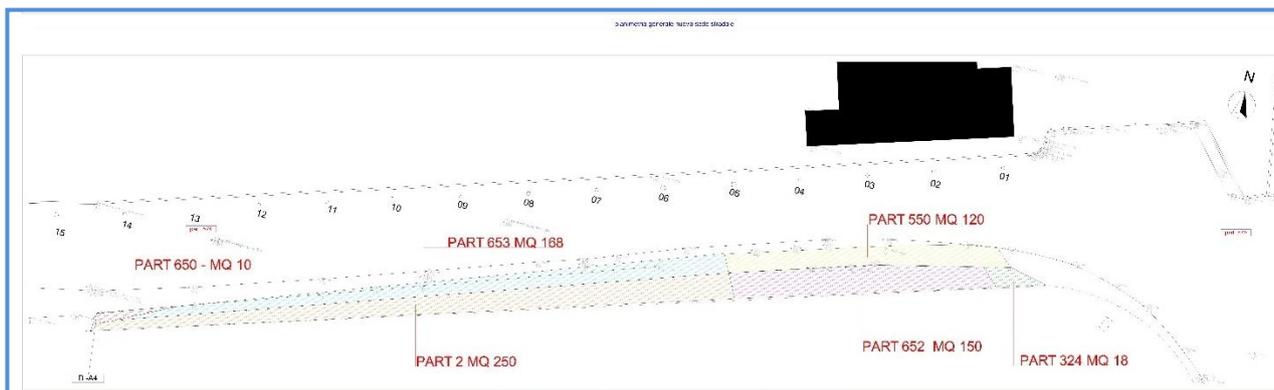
planimetria della strada con in evidenza le particelle interessate dall'intervento
